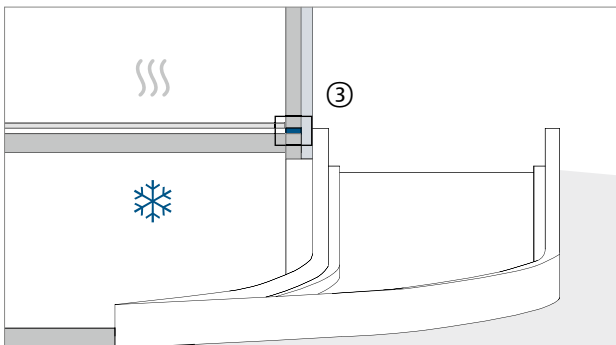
Tiefgarageneinfahrt mit Schöck Sconnex®
